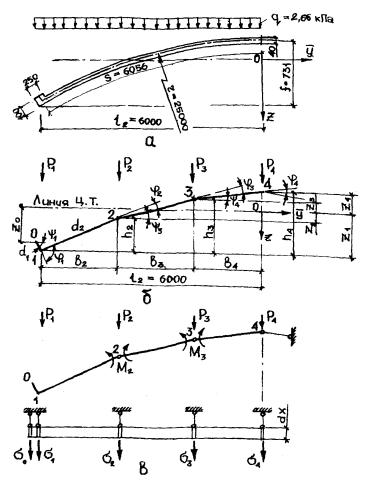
К расчету гибкой пластины-оболочки по деформациям а-геометрическая схема поперечного сечения оболочки и схема поверхностной нагрузки; 6-схема вписанной складки с полосовыми нагрузкими вдоль ребер; в- основная система смещанного метода
